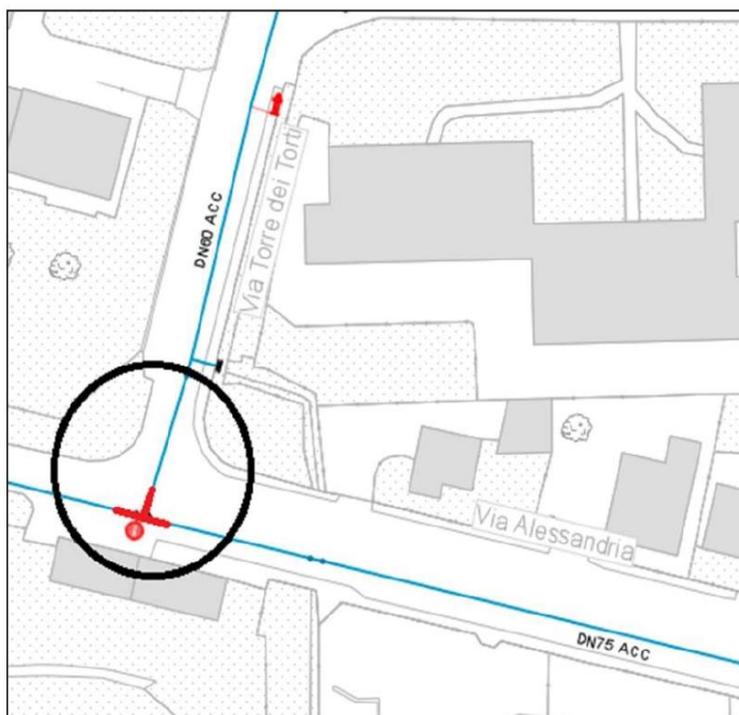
Localizzazione delle saracinesche sotto piastra in cemento lungo Via Alessandria
